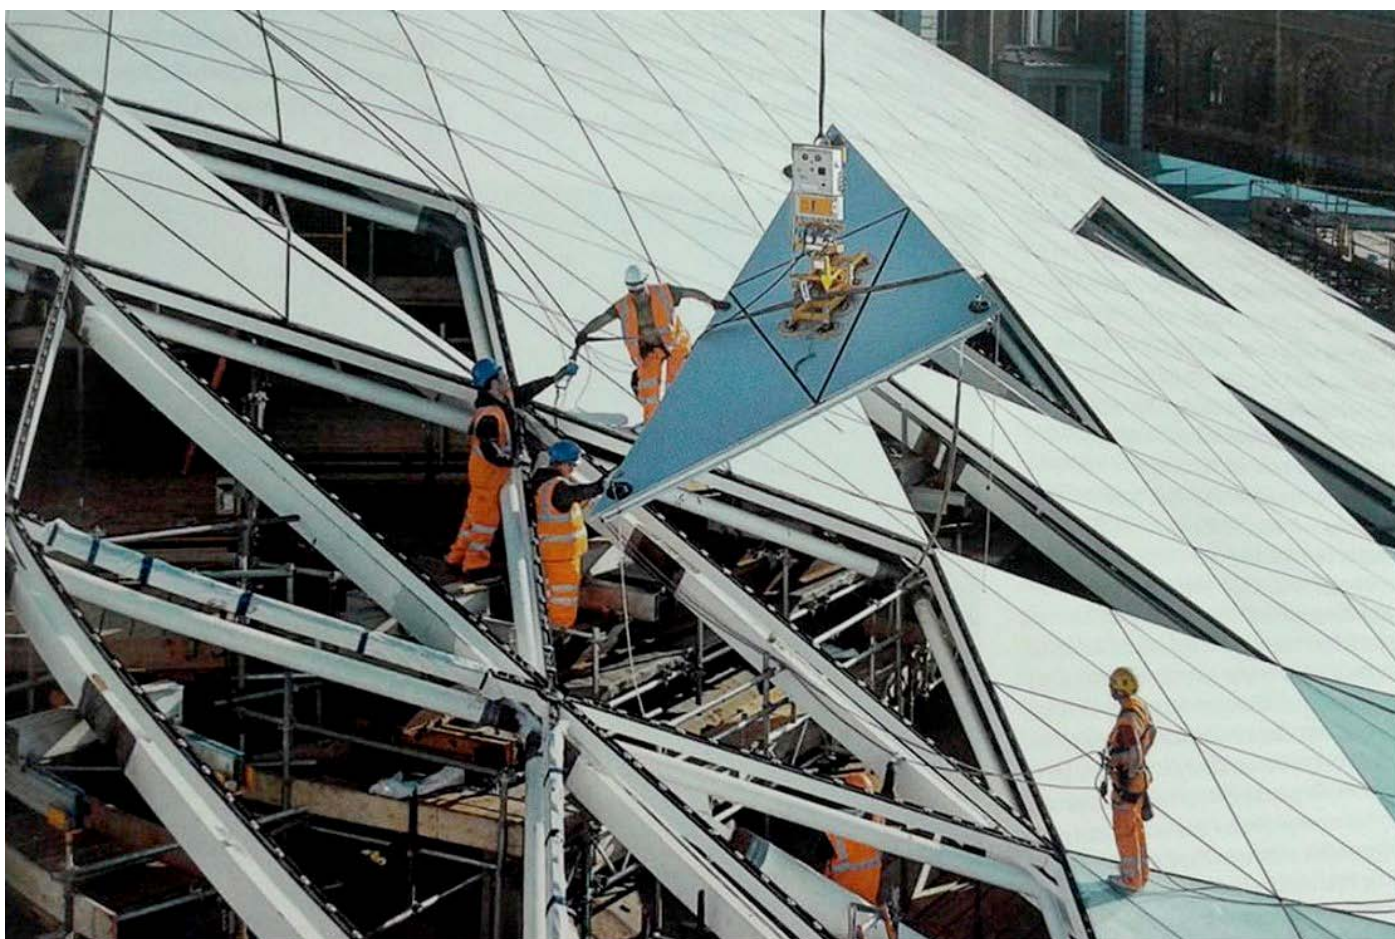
KING'S CROSS RAILWAY STATION. LONDRES. ©: INNOVATIVE DESING+CONSTRUCTION. ED. DETAIL
